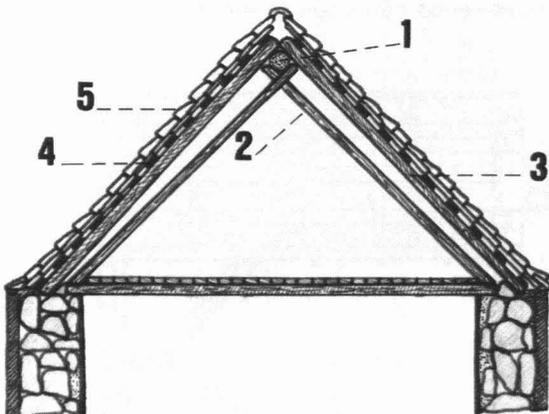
Sistema de montaje en madera para armadura del tejado.
